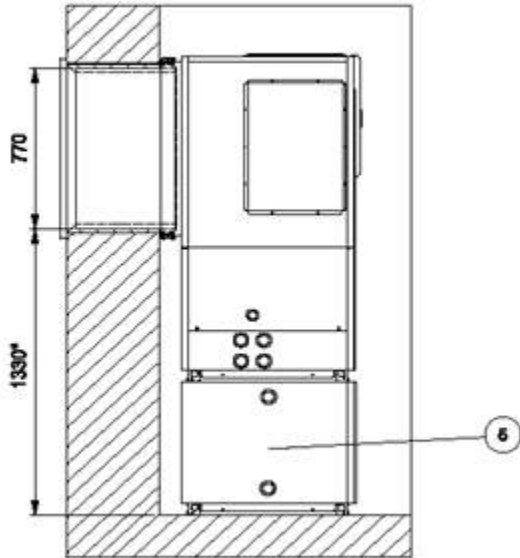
Vue latérale - LI 9TU, LI 12TU et LI 16I-TUR (installation murale - conduit d'air côté refoulement)
